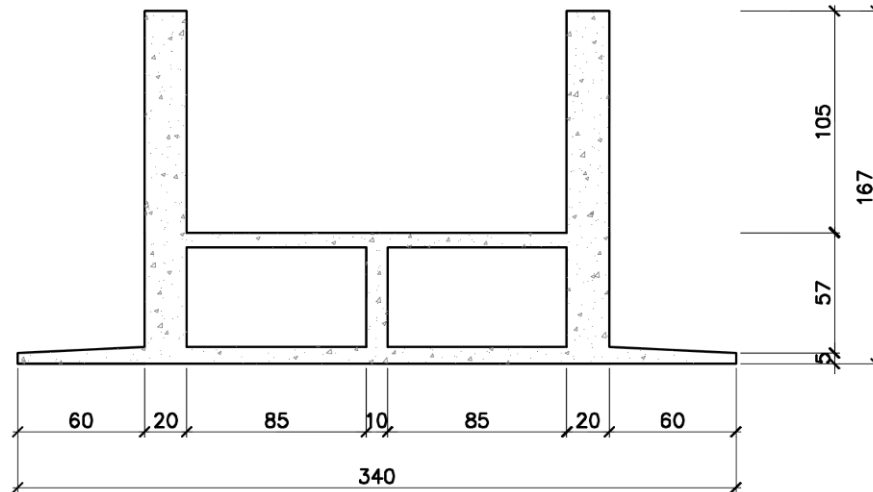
Projeto estrutural: corte transversal típico. Dimensões: centímetros.
